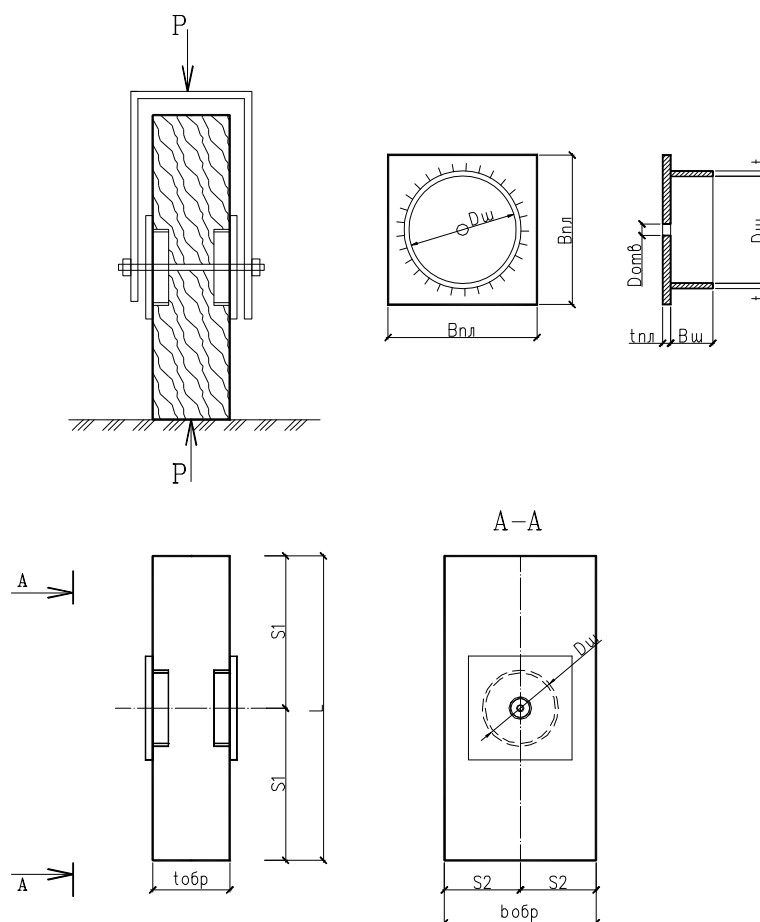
Схема нагружения и основные параметры образцов, испытываемых на ЦККШ
